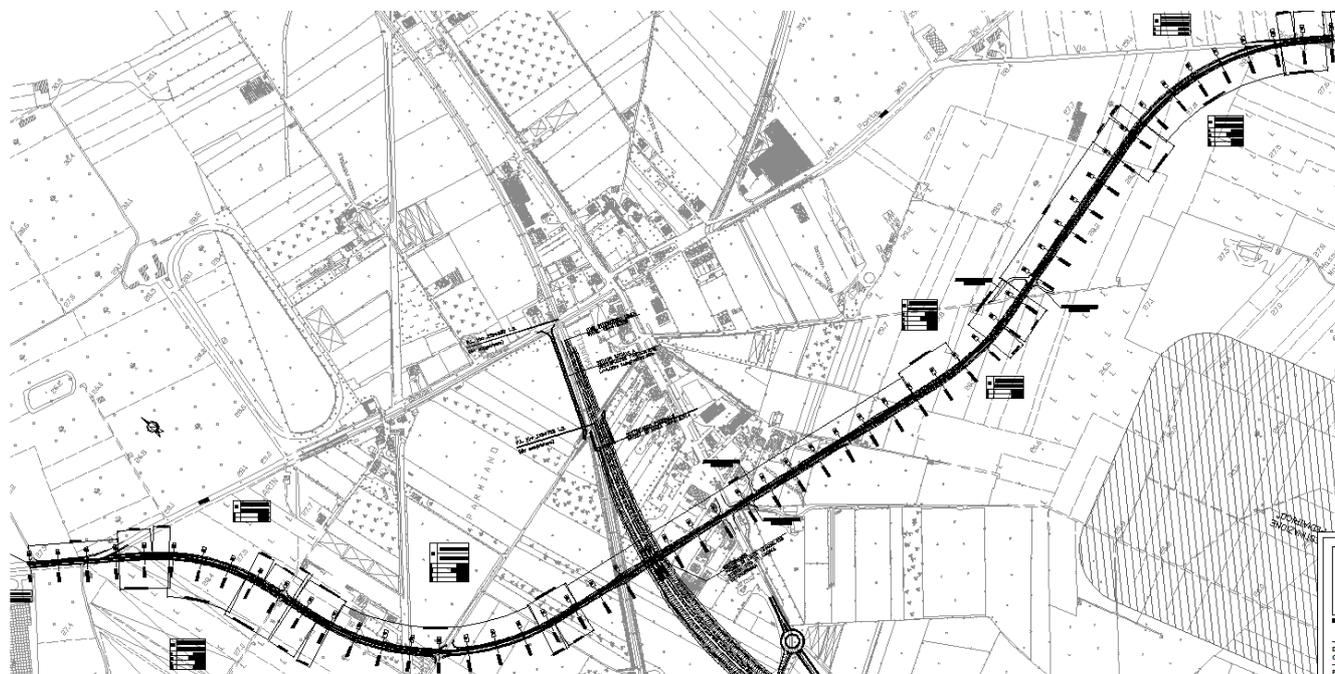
Stralcio planimetrico del PP di L.O. – NV 10 , intera viabilità
